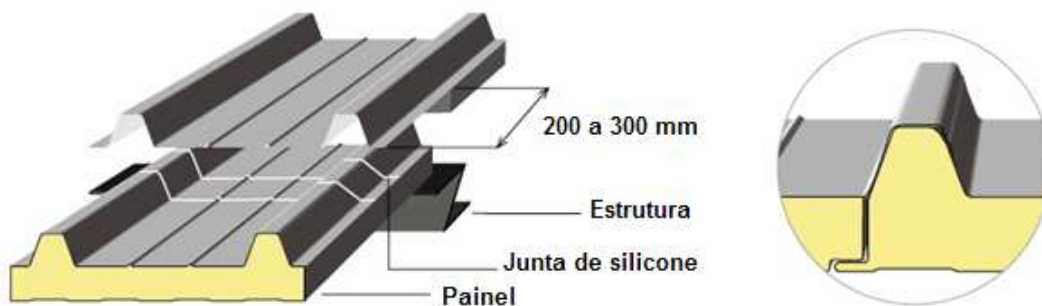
Pormenor de ligação entre painéis sandwich da empresa PERFITEC (adaptada de [65])
